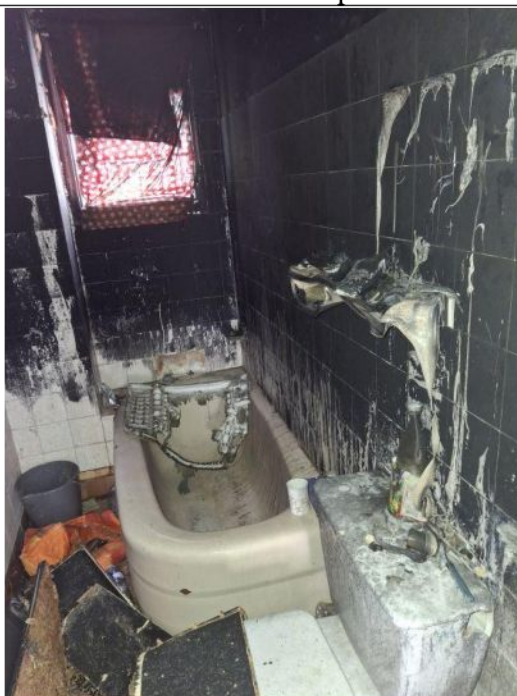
Salle de bain : Risque d'effondrement des cloisons
